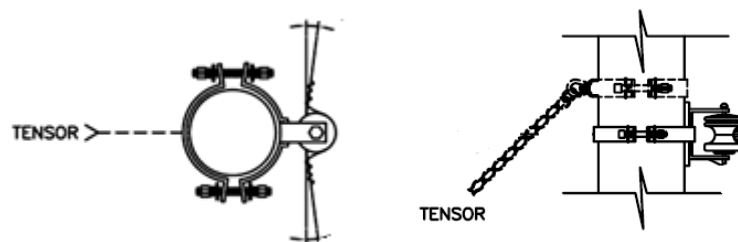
Armado del porta neutro en estructuras EST-3SA.
